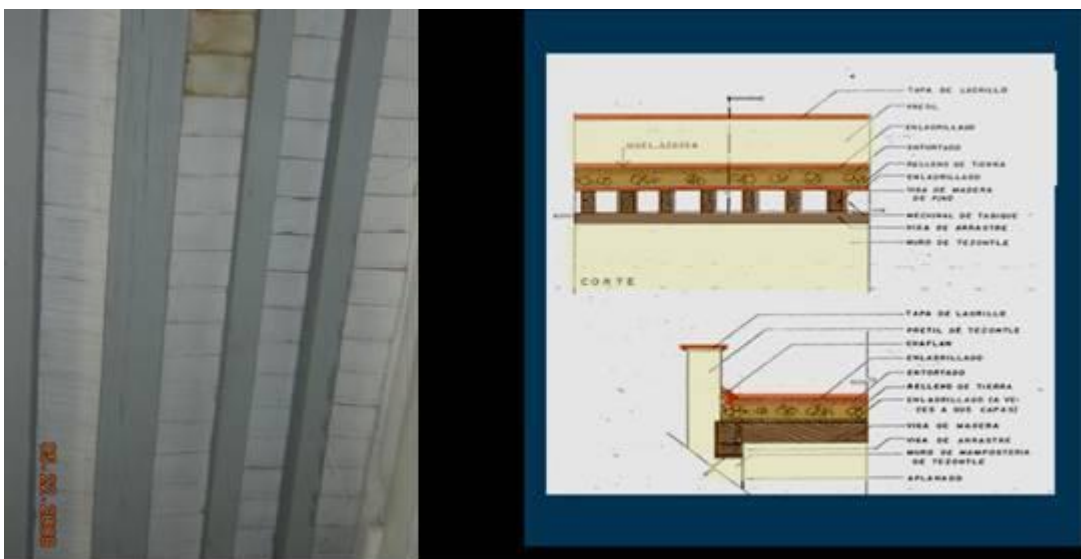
Estado actual de cubierta de vigerías de una habitación de vigería de zaguán de la Casa 6 oriente y esquina 5 de mayo no. 1.
